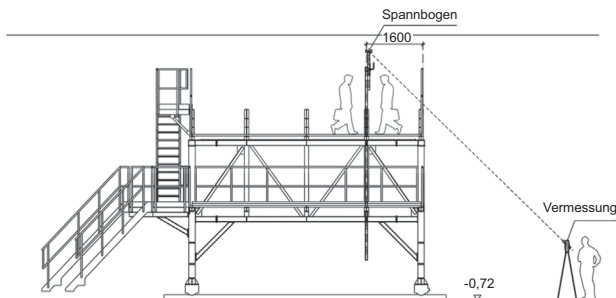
Platzierung des polygonalen Rohrs am Bewehrungswagen
